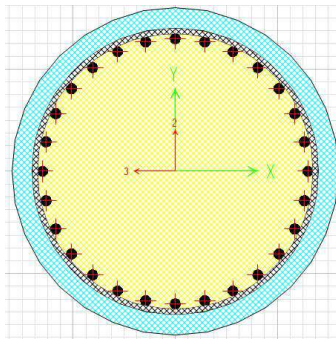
Modelo de la sección de pilares en “Section Designer” del SAP2000.
